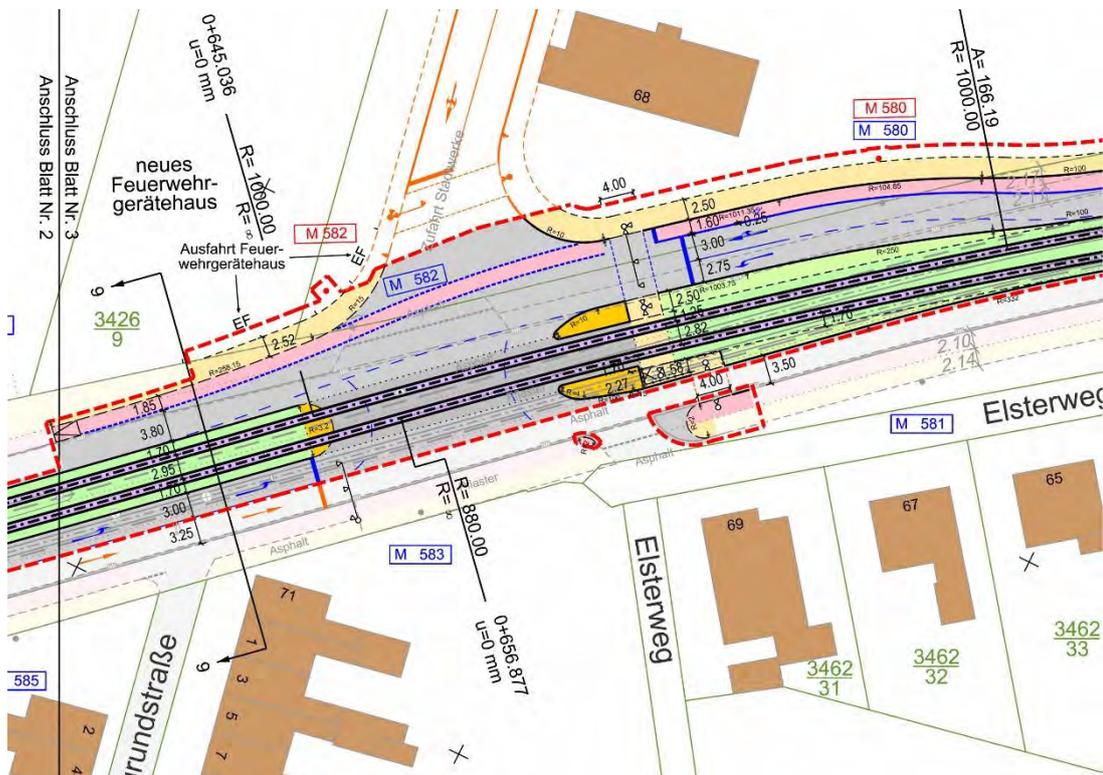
Vorabzug Lageplan Planung Anschluss Stadtwerke<sup>13</sup>
